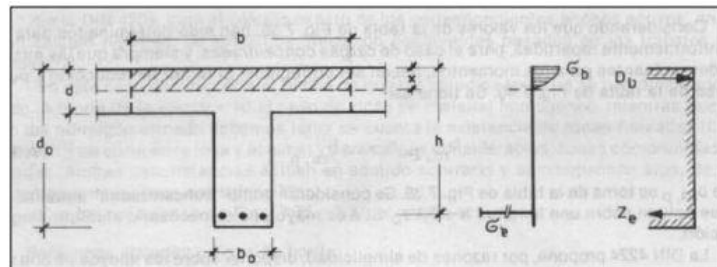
Diagrama de sección de Viga “T” para losa nervurada.
